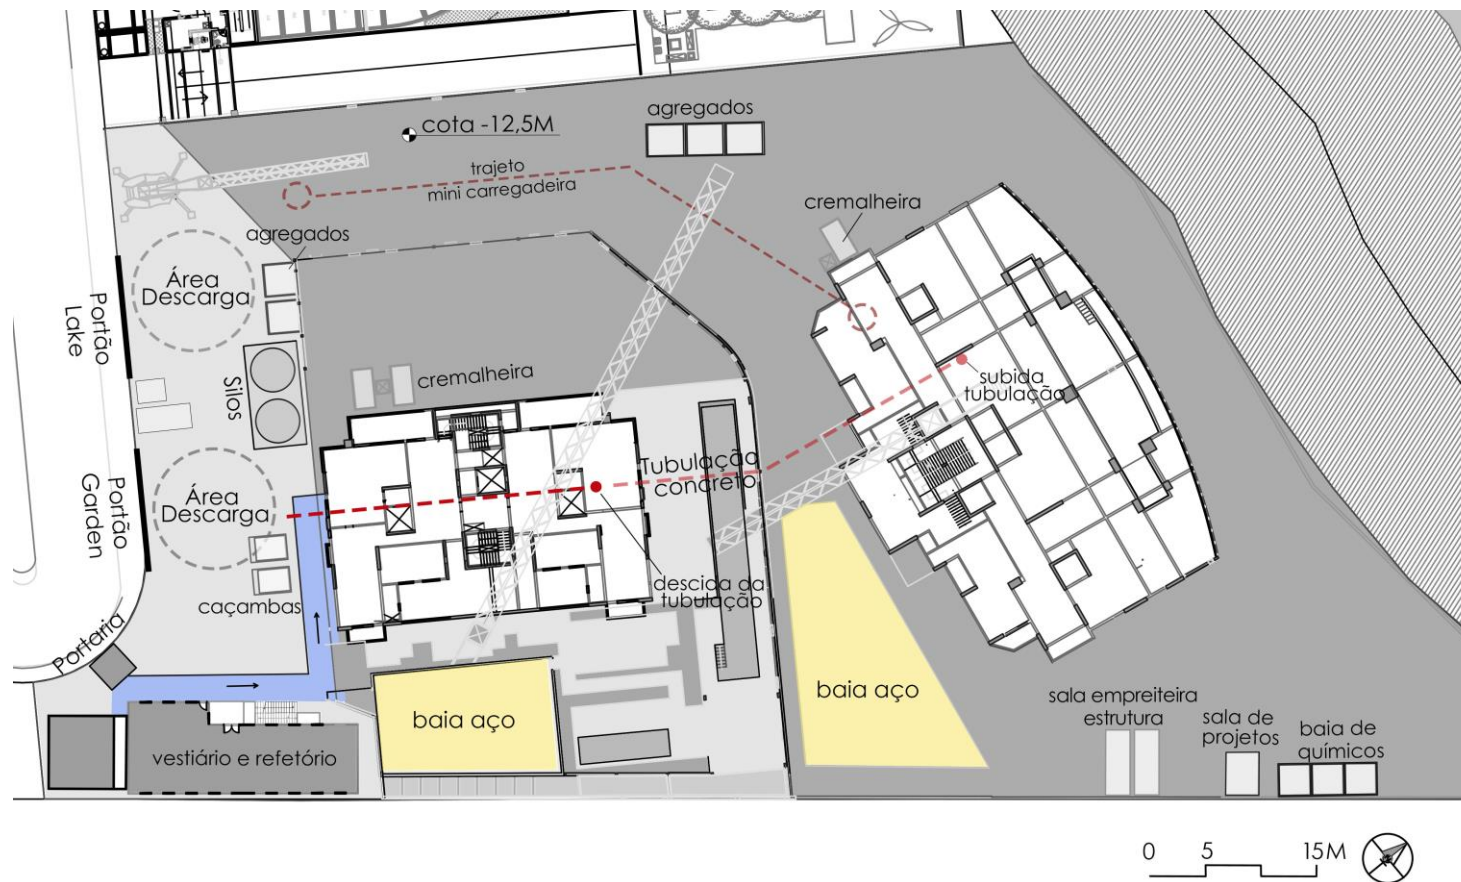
Layout do canteiro de obras na fase de produção da estrutura do embasamento da torre “B”. Autor: Giovani Vespe.
